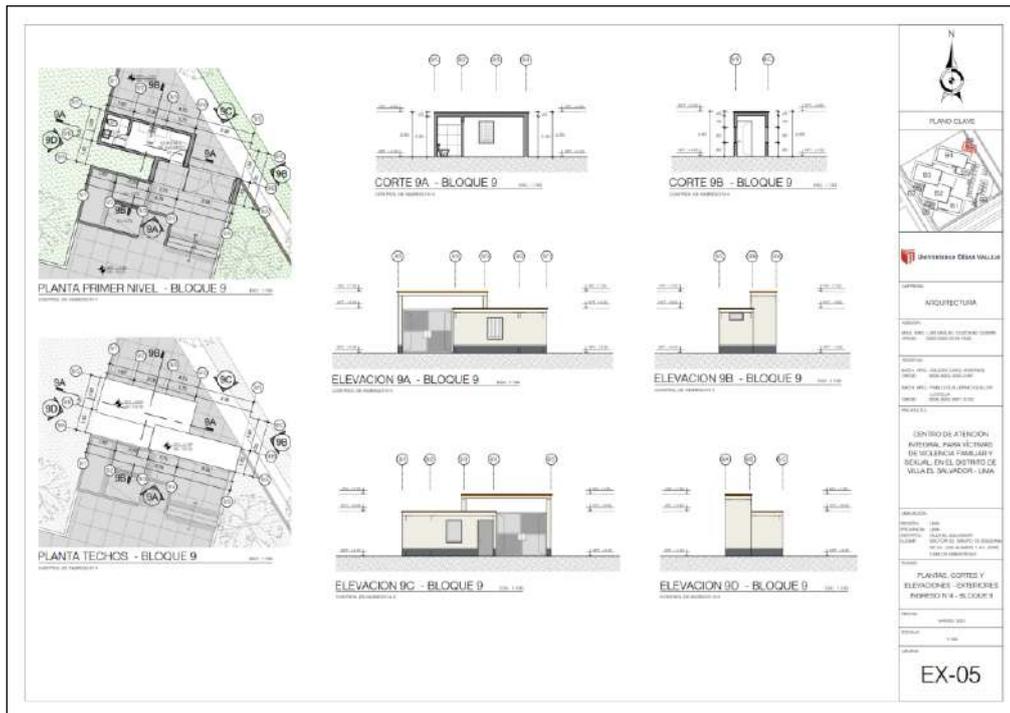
Plantas, cortes y elevaciones, exterior ingreso 04.
